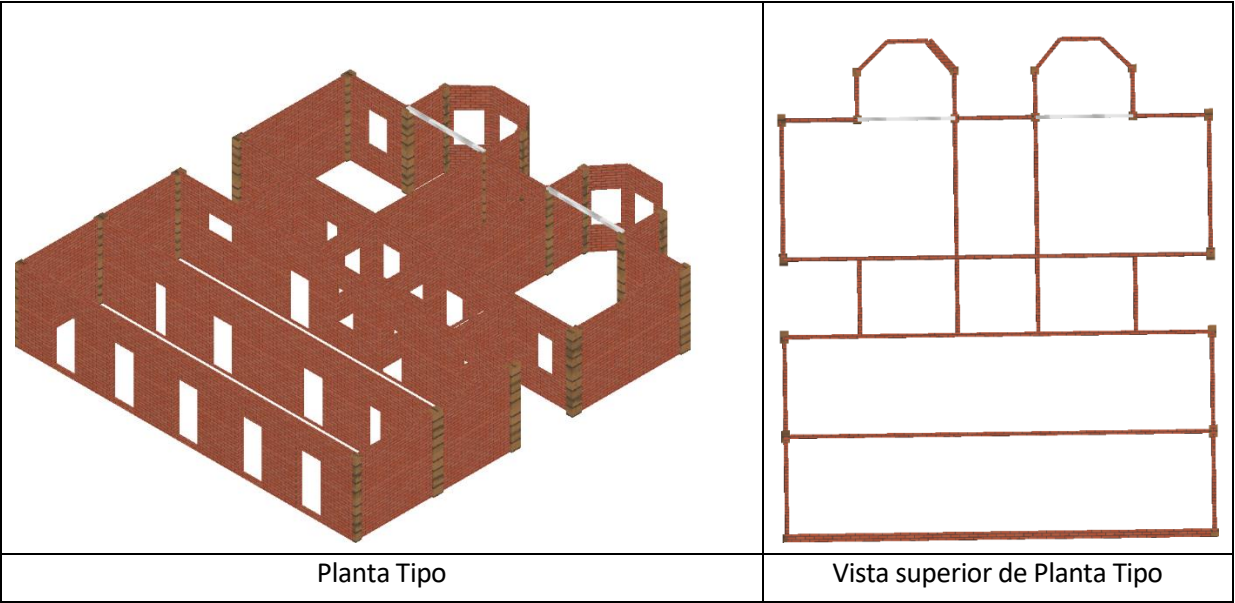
Modelo de Planta Tipo (Fuente: Propia)
